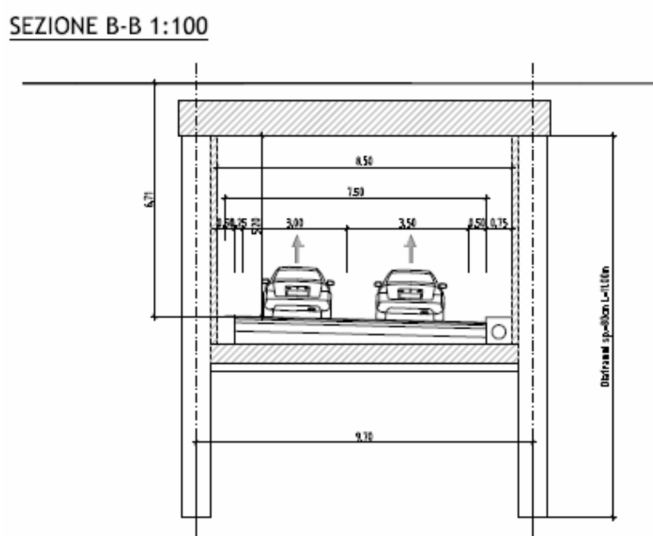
Sezione trasversale scatolare interrato (estratto da elaborato B831-C-SF-STR-RT001A)
